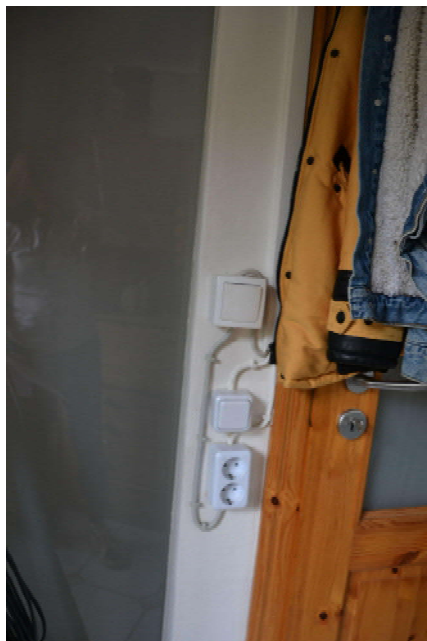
Erdgeschoss Hauswirtschaftsraum, 1. Zimmer rechts, elektr. Leitungen auf Putz
